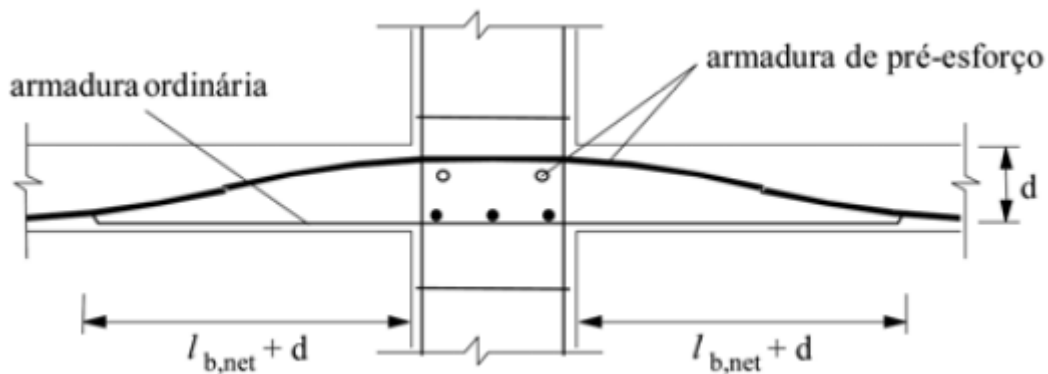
Armadura de colapso progressivo em pilar interior [15].
